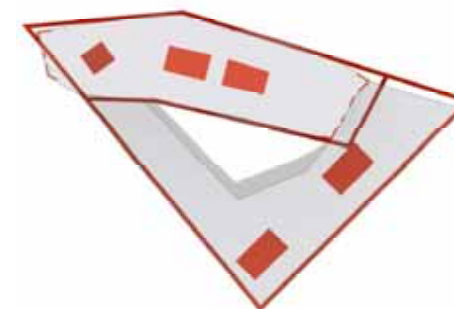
Kernanordnung im Grundriss, Außenwände des Kellerkastens
